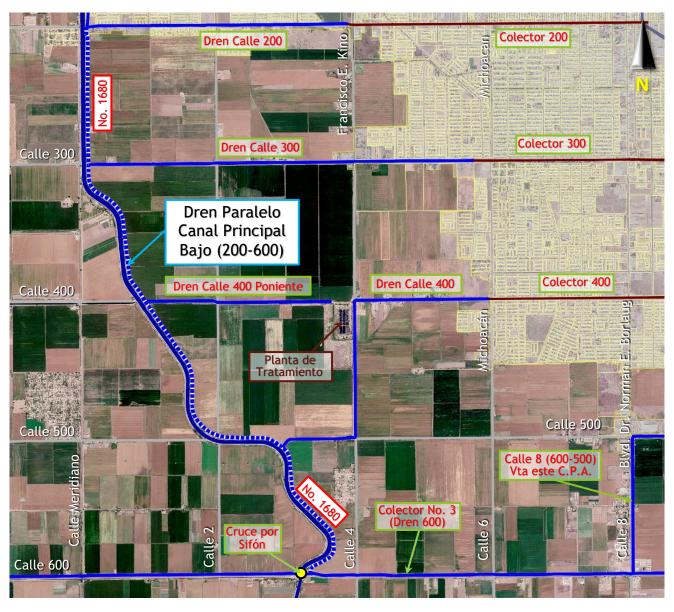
Croquis de ubicación del Dren Paralelo al Canal Principal Bajo.
